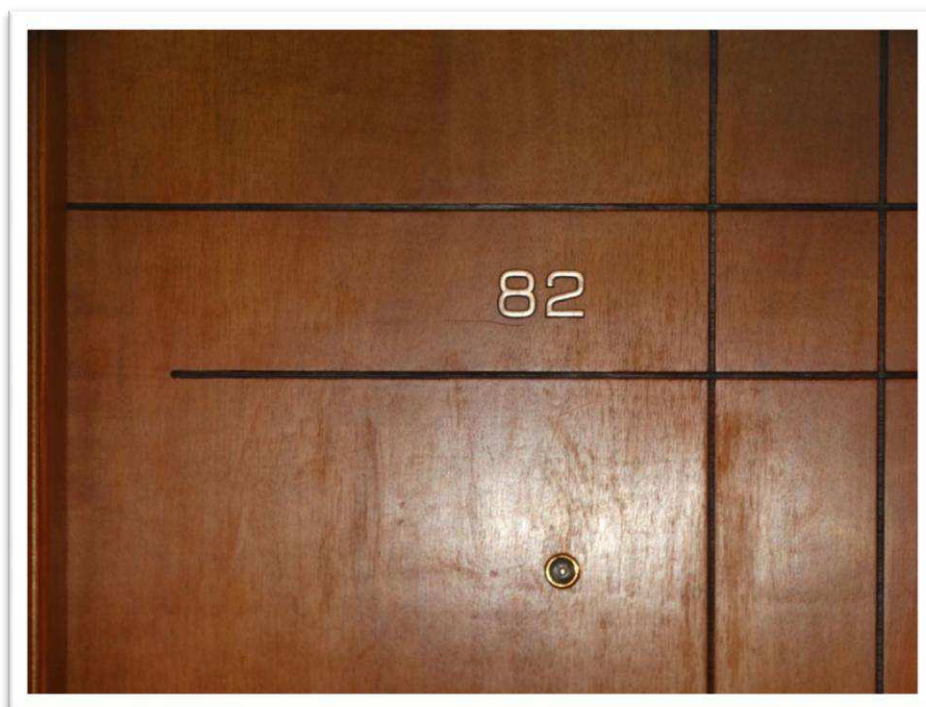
Vista da numeração do apartamento objeto da lide, de nº 82, localizado no 8º pavimento do Bloco “B”.
